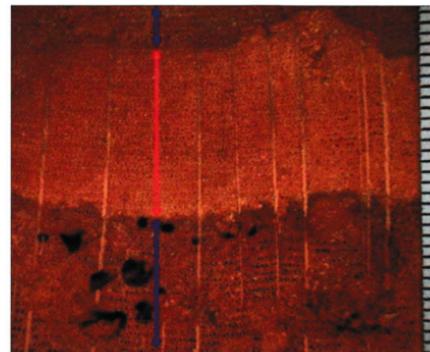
Ausgebreiteter Hausporling (†) und Kellerschwamm (†), Detail: eng verwobene Befälle in einem Bauteilausschnitt; Maßstab mit Millimetern.
